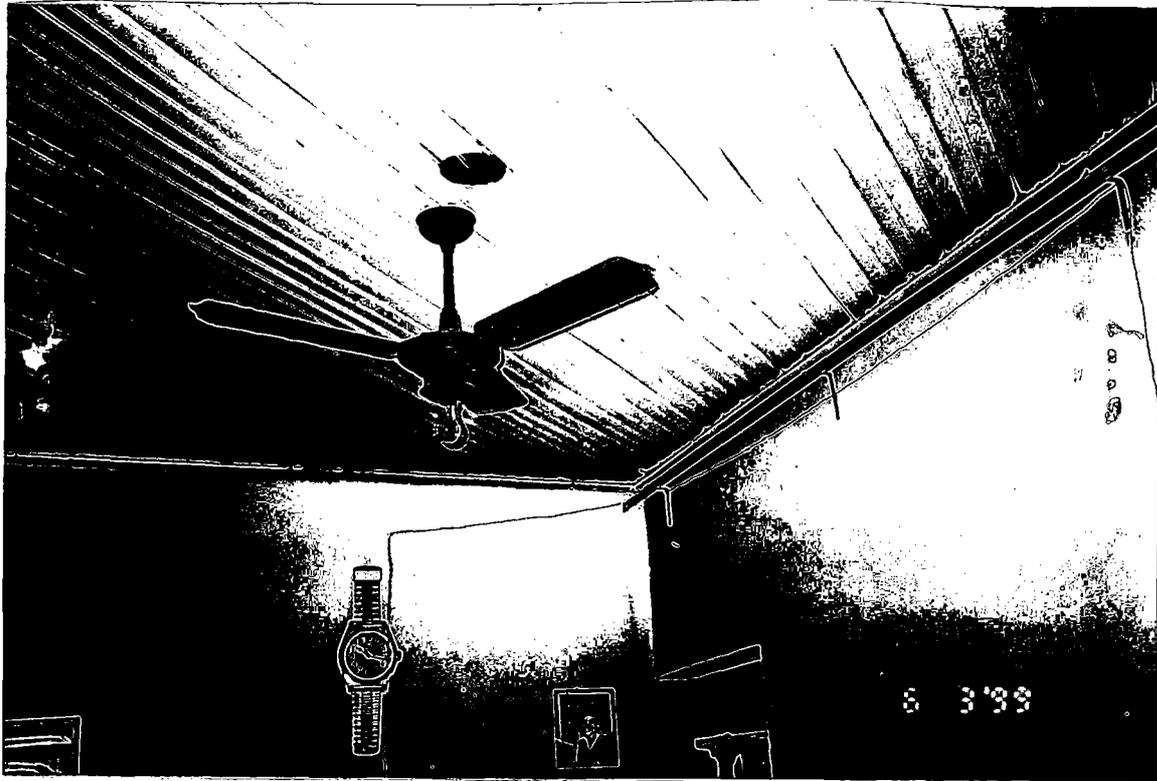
OUTRA VISTA DA SALA - OBSERVA-SE FORRO DE MADEIRA
